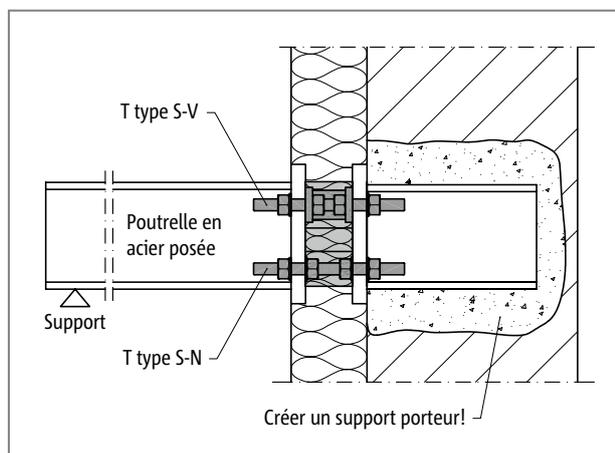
Schöck Isokorb® T type S-N et T type S-V : construction en acier supportée ultérieurement; pour d'autres exemples de rénovation, voir p. 96
